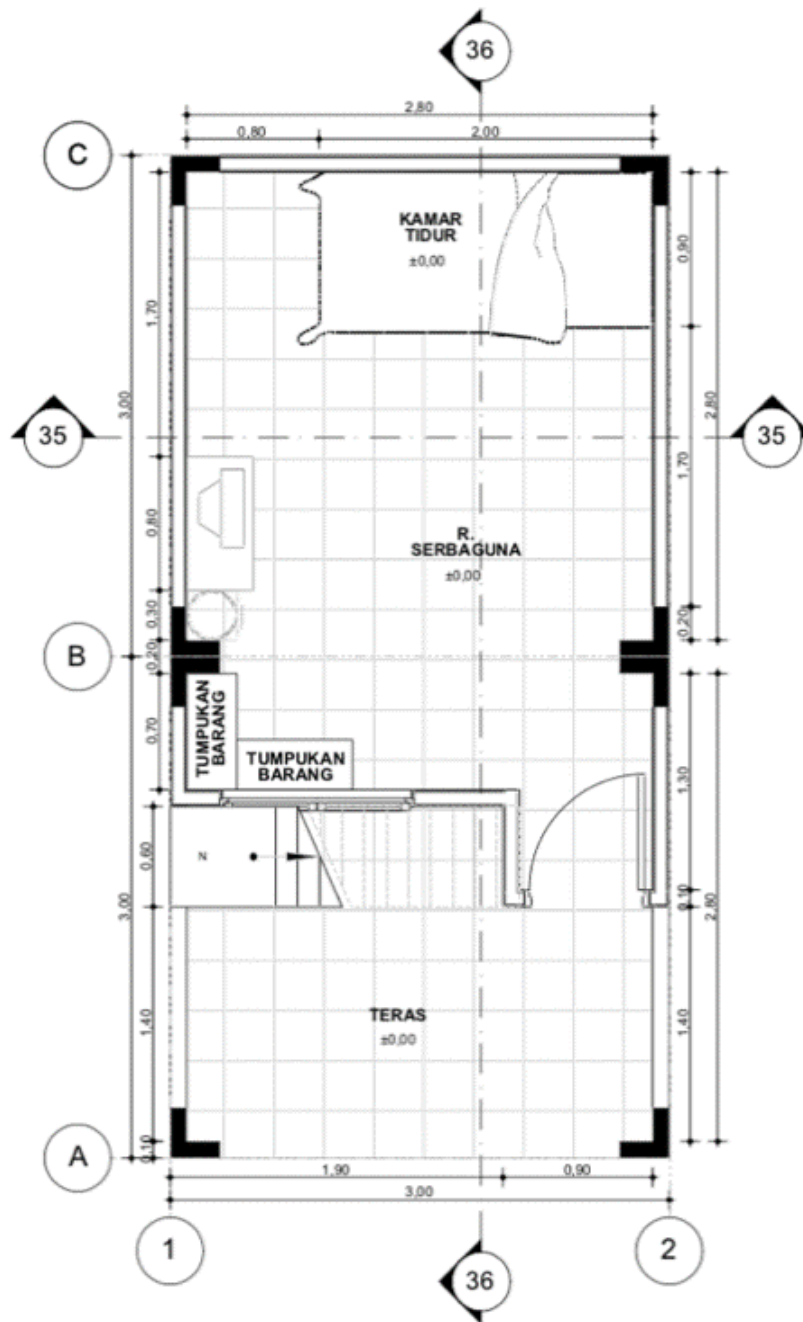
Layout* Denah Lantai Satu Tipe 36
